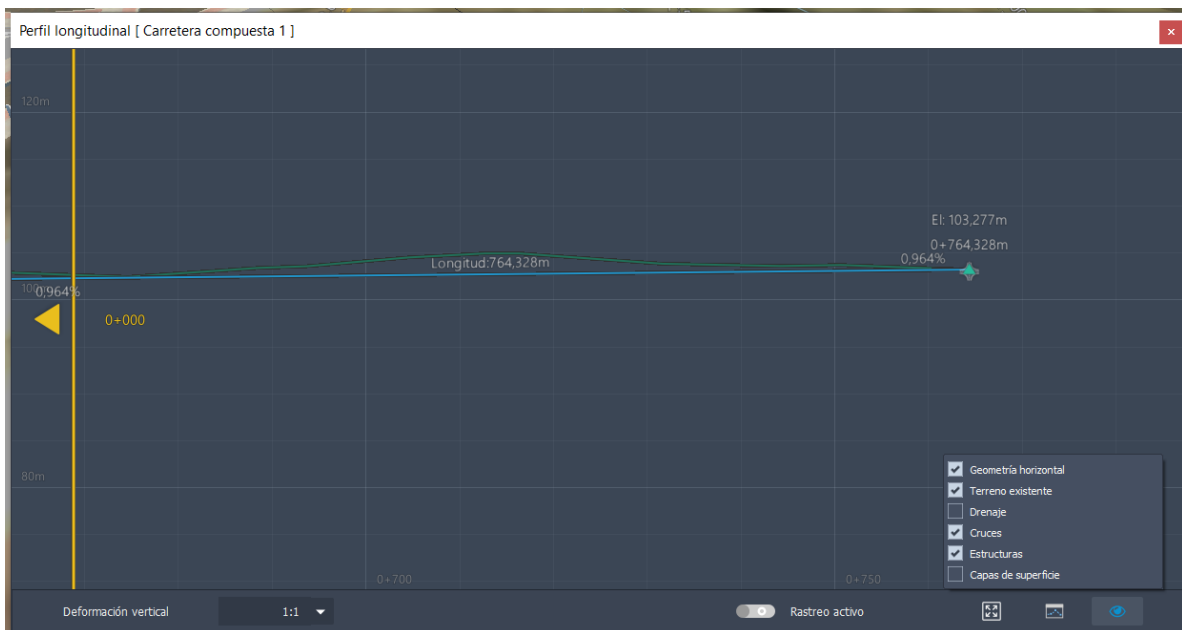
Perfil longitudinal + terreno existente, cruces y estructuras.
